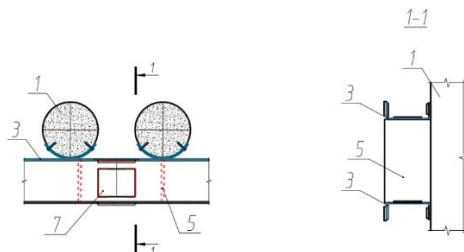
Схема узла крепления грунтовых анкеров к обвязочному поясу: 1 – буроинъекционная свая ЭРТ; 2 – упор анкерного пояса; 3 – анкерный пояс из стальных профилей; 4 – стальная пластинка; 5 – ребра жесткости анкерного пояса; 6 – стержень из высокопрочной арматуры анкерного пояса; 7 – узел крепления стыка анкерного пояса
